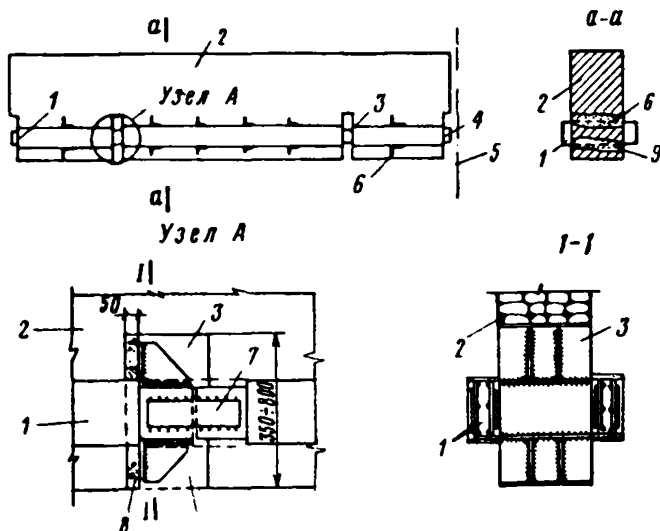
Схема усиления ленточного фундамента железобетонными поясами
